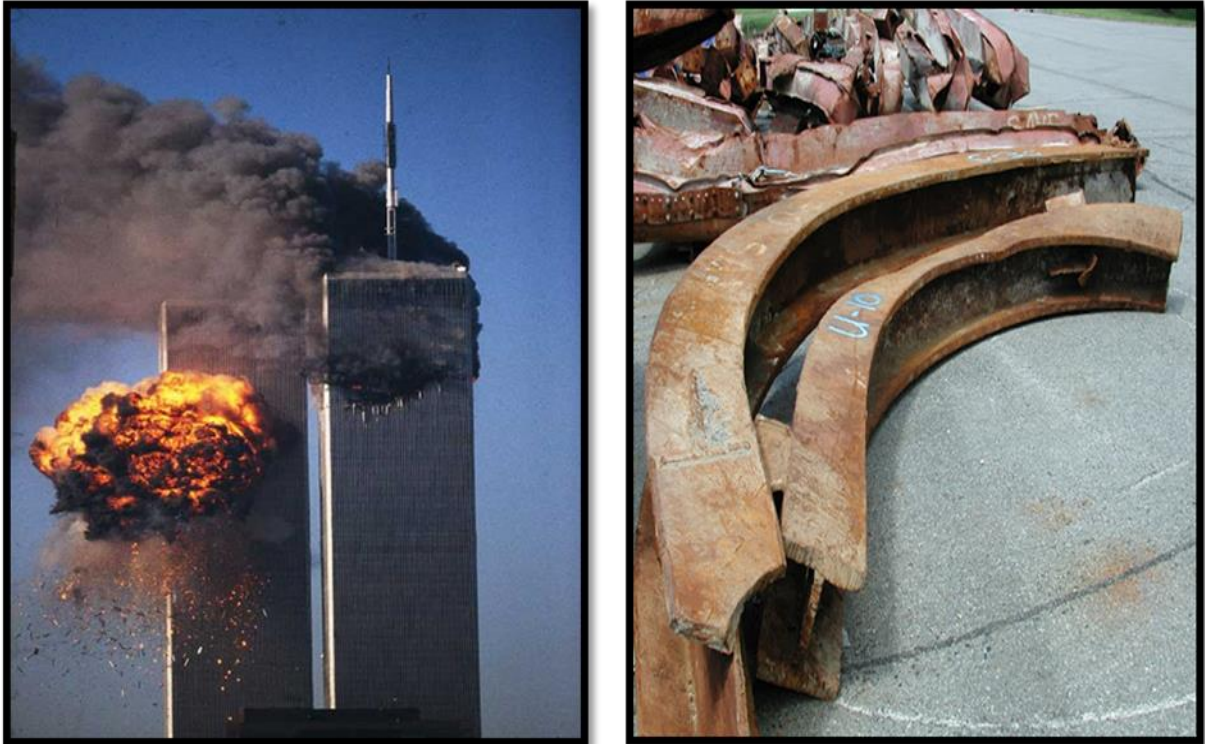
Impacto de la explosión en la Torre Sur de las Torres Gemelas (izquierda) y perfiles de acero después del incendio causado por la explosión (derecha)
